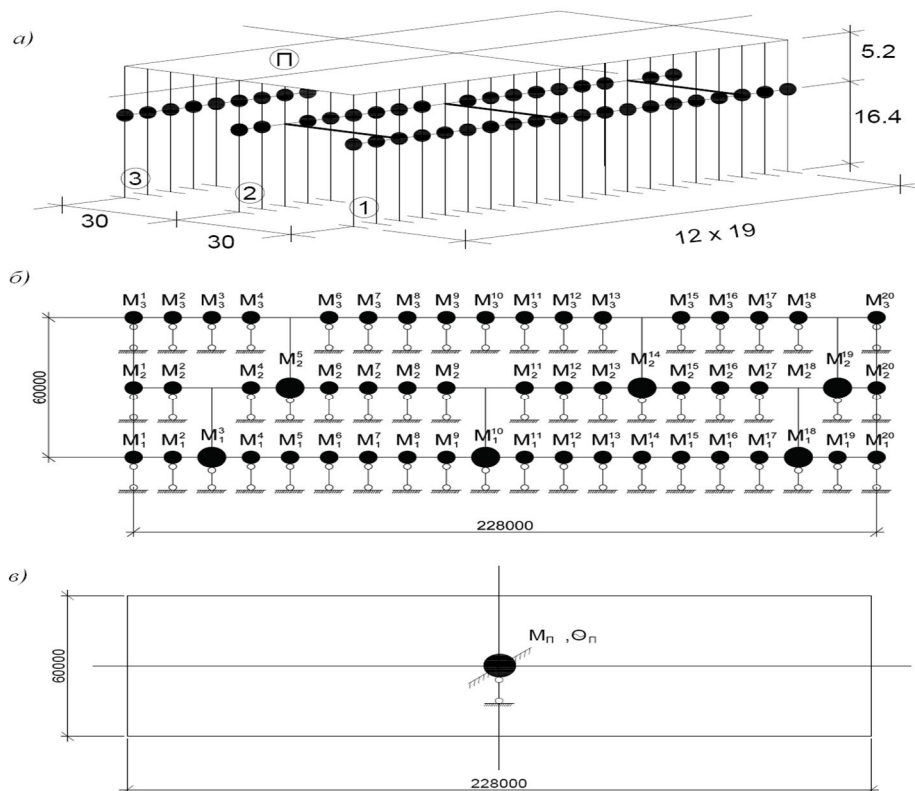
Расчетная схема одноэтажного промышленного здания, оборудованного мостовым краном: а – аксонометрия расчётной схемы; б – расчетные точки в уровне подкрановых балок; в – расчетная точка на покрытии
